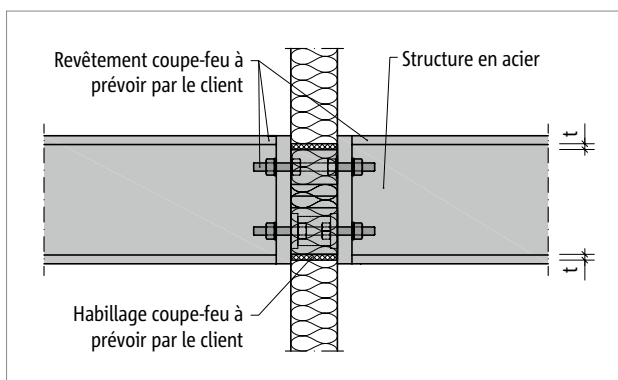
Schöck Isokorb® T type S : habillage anti-feu prévu par le client pour l'Isokorb® T type S, structure en acier avec revêtement de protection incendie ; vue en coupe
